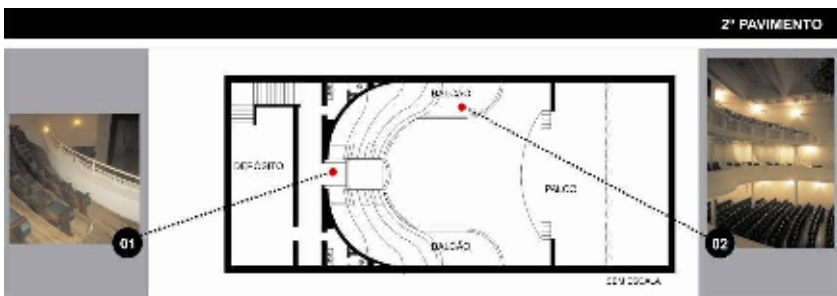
Segundo pavimento do TAC – balcão. Fonte: Autora (2009).
